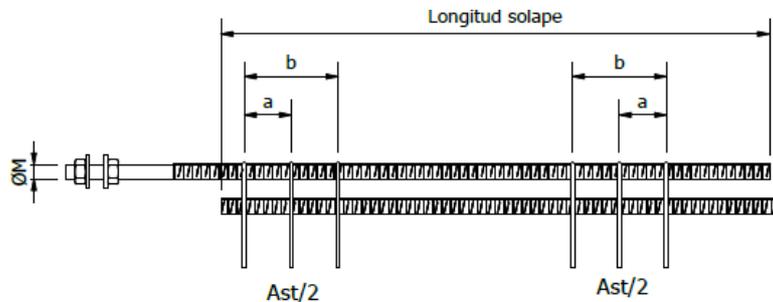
Longitud de solape i cotas para la armadura transversal
